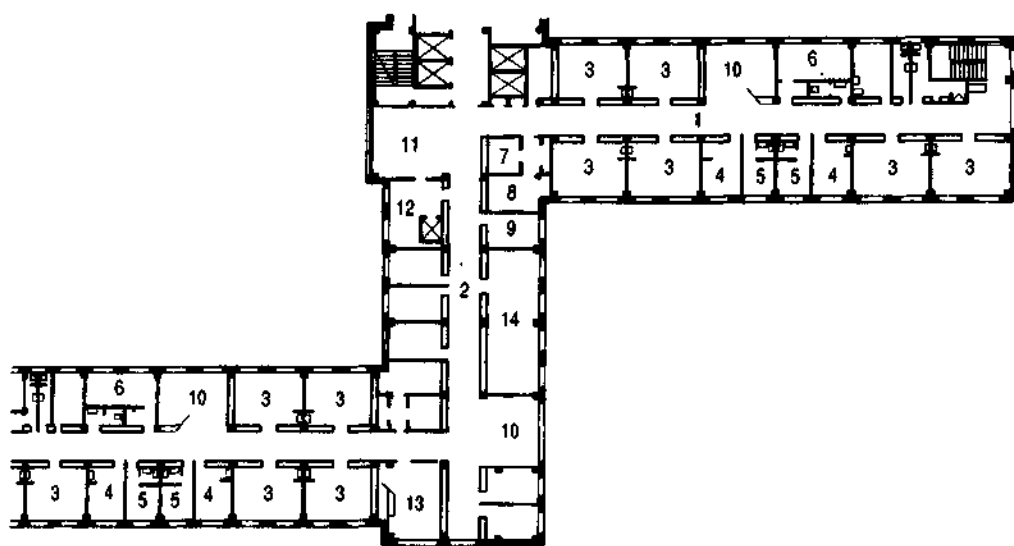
План типового отделения на 60 коек в районной больнице на 300 коек.
